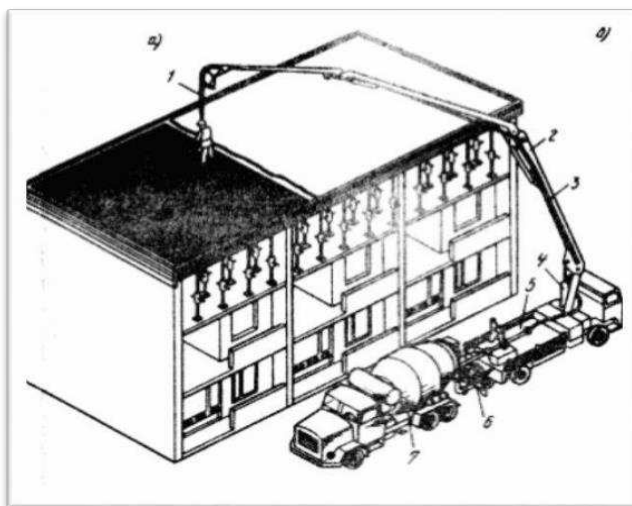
Подача бетонной смеси автобетононасосом
